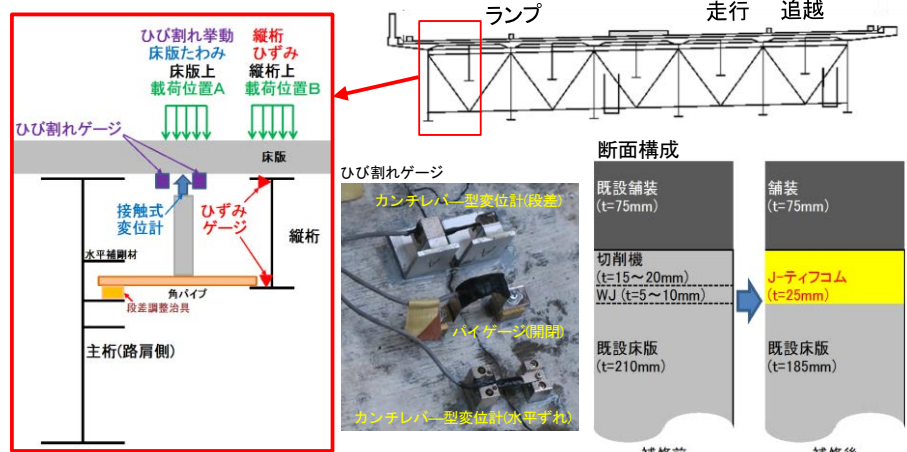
計測位置、補修前後の床版断面構成、ひび割れ挙動の計測器設置状況
